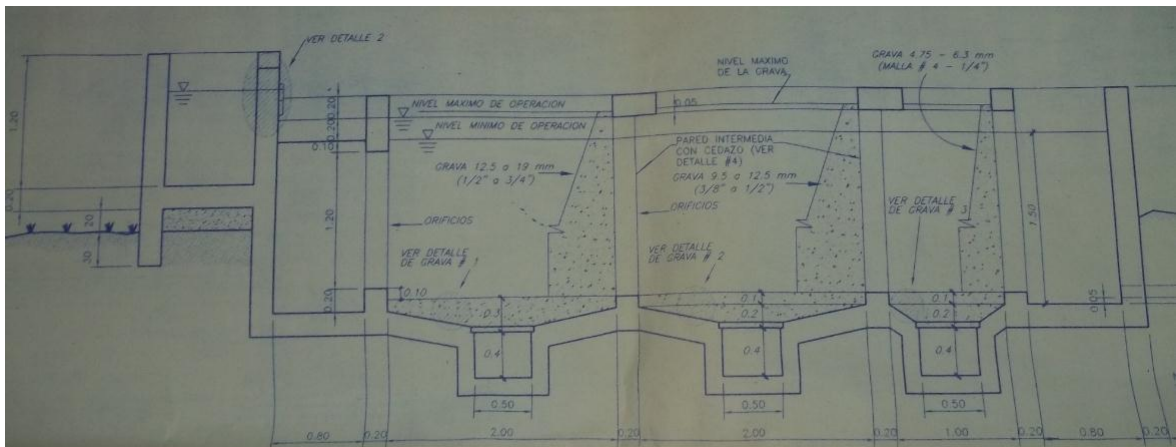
Corte Lateral del filtro grueso horizontal de la planta de tratamiento quebrada Tarbaca. Fuente Elaboración Propia.
